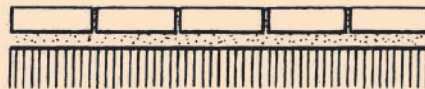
Disposición tizón en plano con junta estrecha (aprox. 3 mm).
